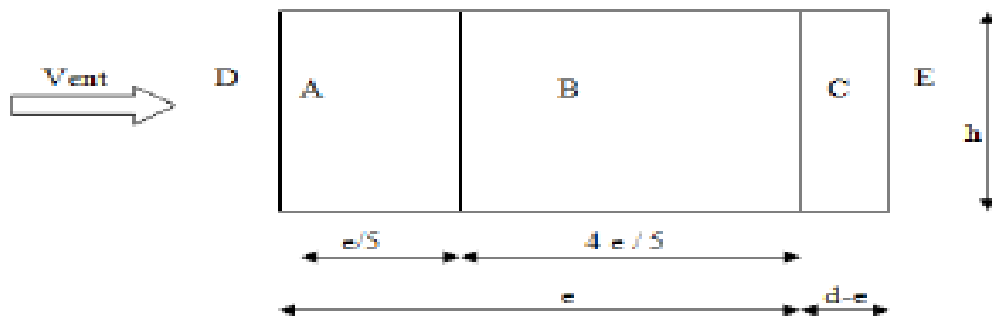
Vue en plan des zones de pression sur les parois verticales suivant le long pan.
